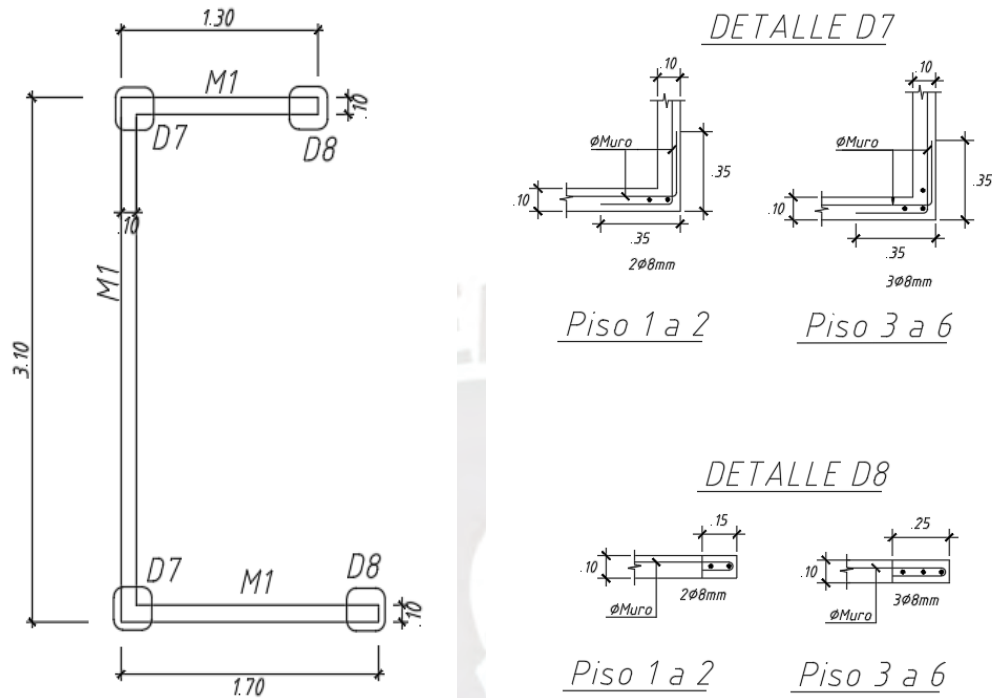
Detalle estructural de sección y bordes confinados de muro M1
